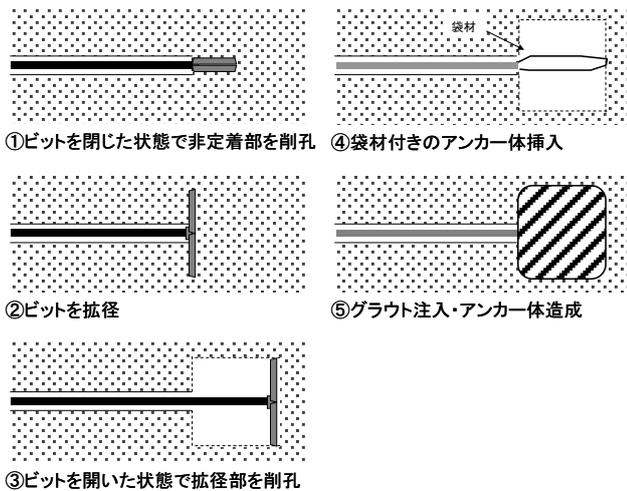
拡径削孔方式の拡径型アンカー工法の施工方法
